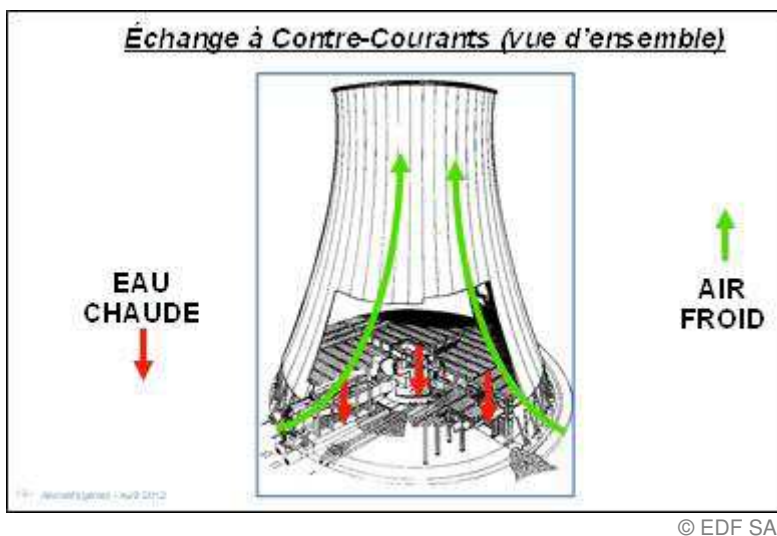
Vue d'ensemble d'une tour aéroréfrigérante
